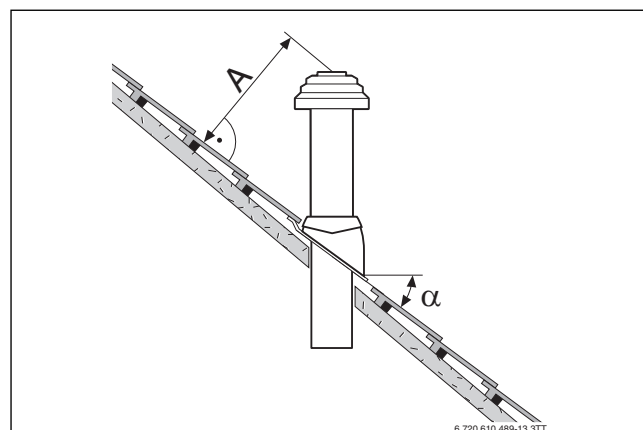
Distanza da mantenere e inclinazioni del tetto con tetto inclinato
